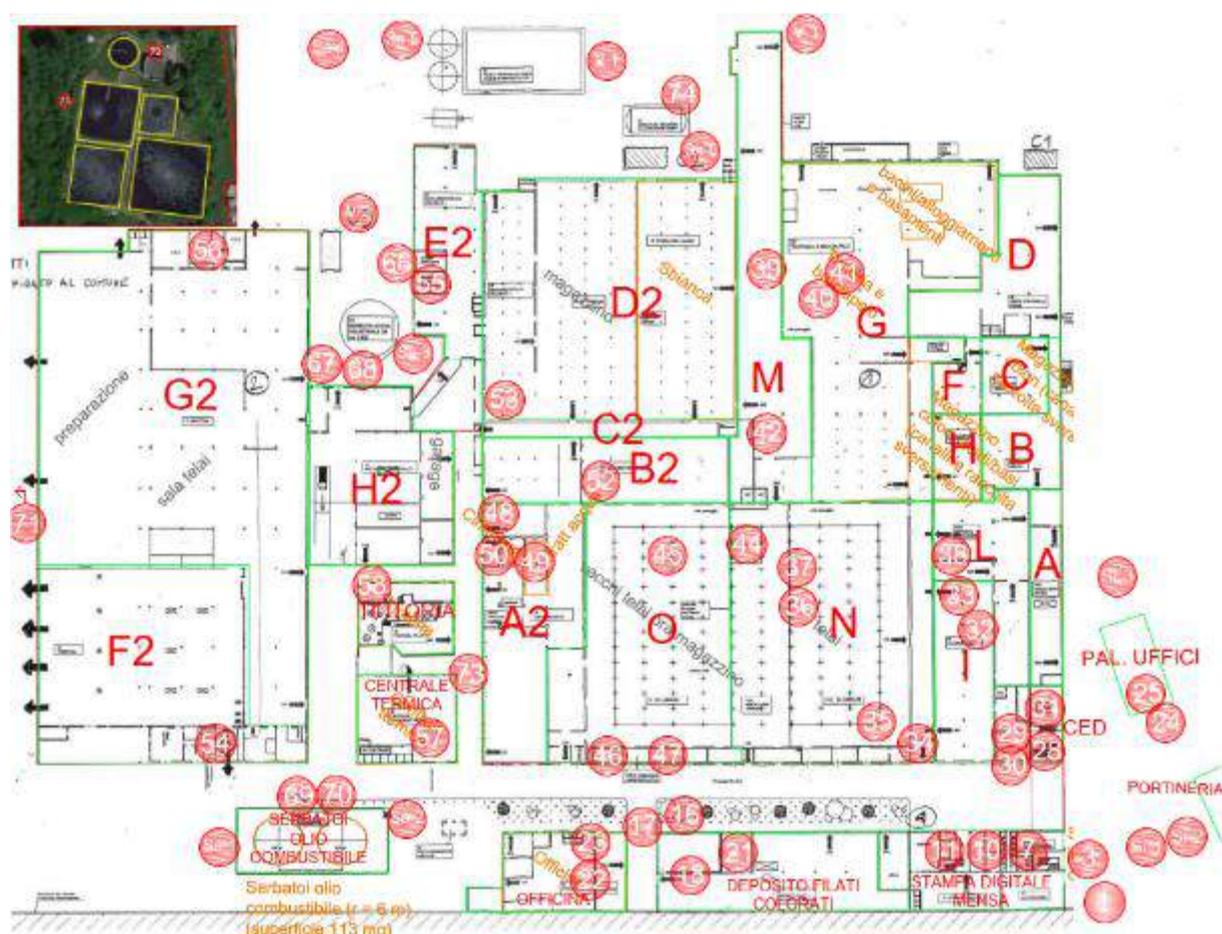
Stralcio planimetrico con individuazione dei punti di campionamento su aree esterne e all'interno degli edifici accessibili (si rimanda all'APPENDIX E).
